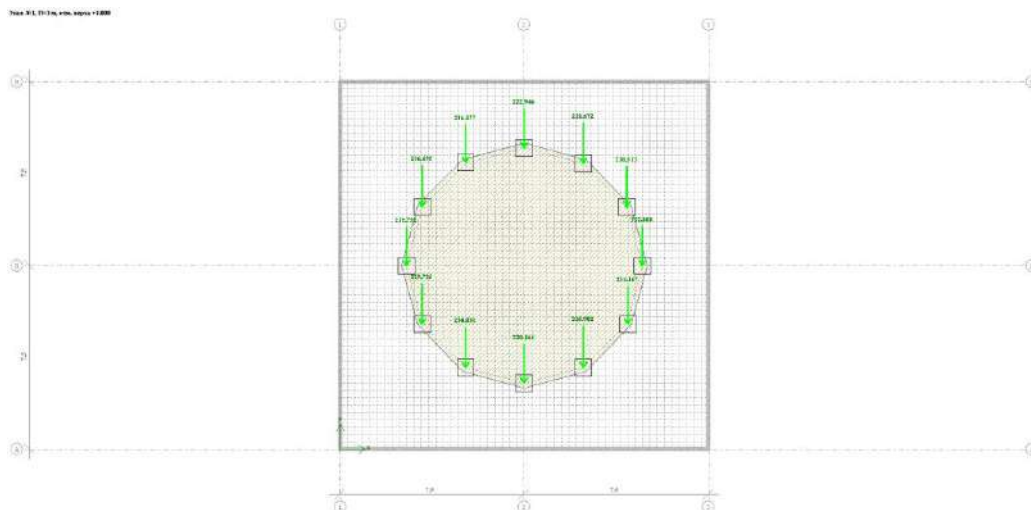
Вариант 1 Фундаментная плита на естественном основании
